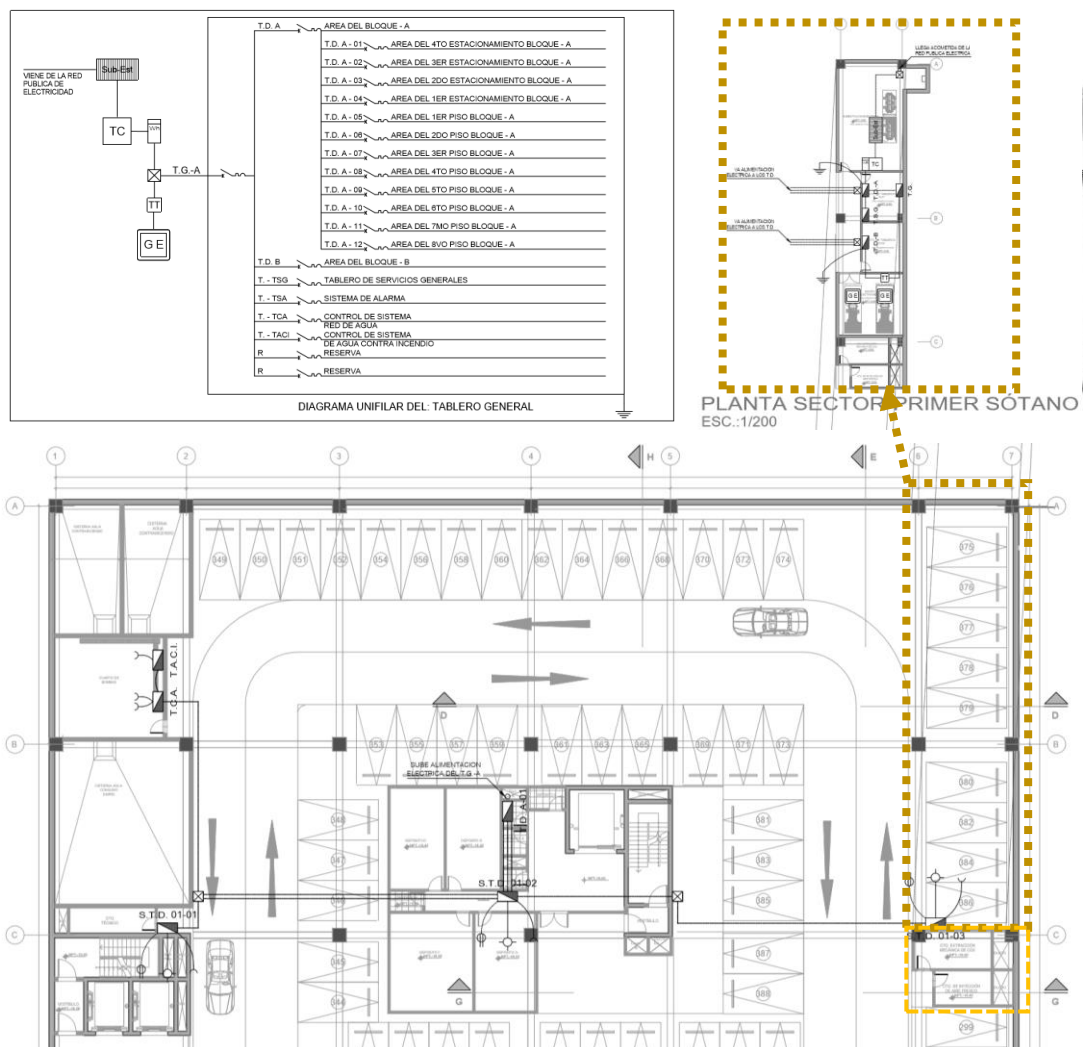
Vista superior del diagrama unifilar del tablero general empleado en el proyecto y al lado un sector de la planta del primer sótano donde se ubica el grupo electrógeno, la subestación eléctrica y los cuartos de tableros. (color marrón) Vista inferior planta de un sector del cuarto sótano donde se ubica de forma típica los cuartos de inyección y extracción para ventilación mecánica de sótanos. (color amarillo)
